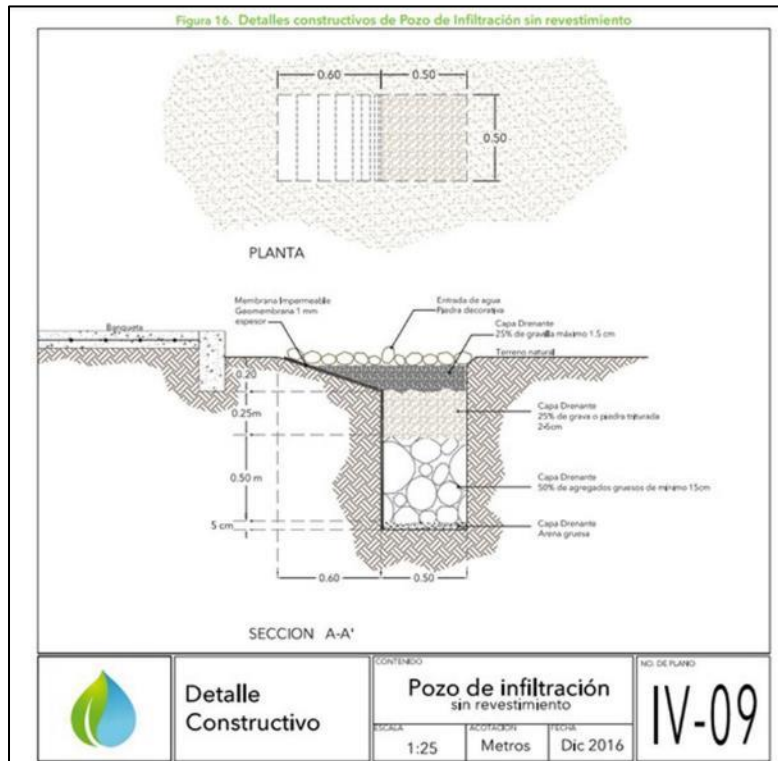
Detalles constructivos del pozo de infiltración sin revestimiento.
